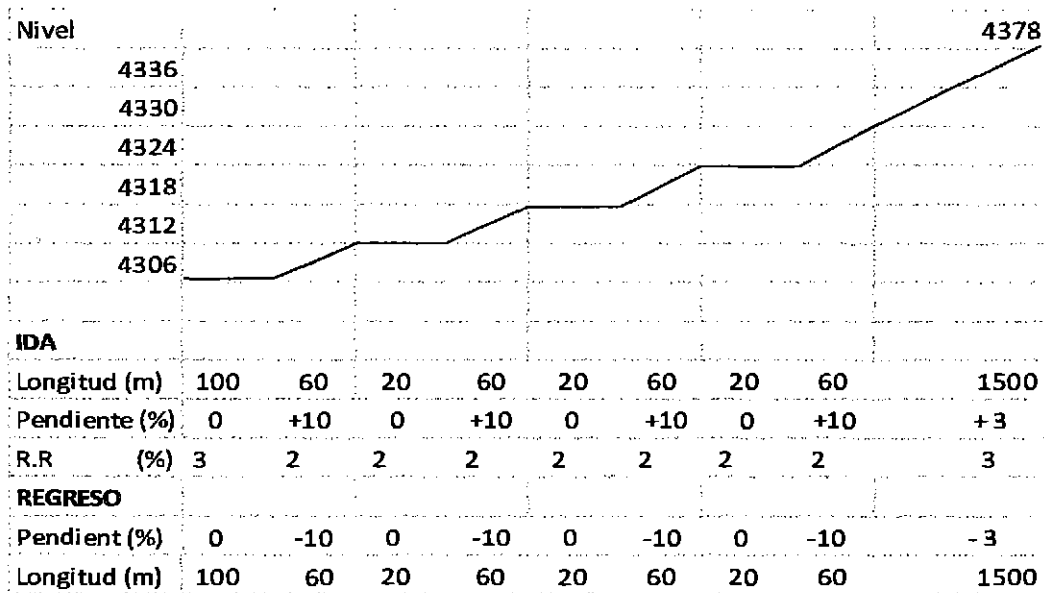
Alzado del perfil de transporte Ruta N° 01
